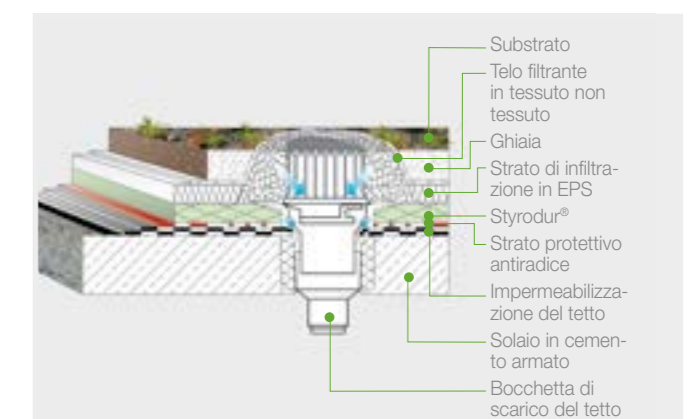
Bocchetta di scarico di un tetto verde rovescio con uno strato di drenaggio in lastre drenanti di EPS.
